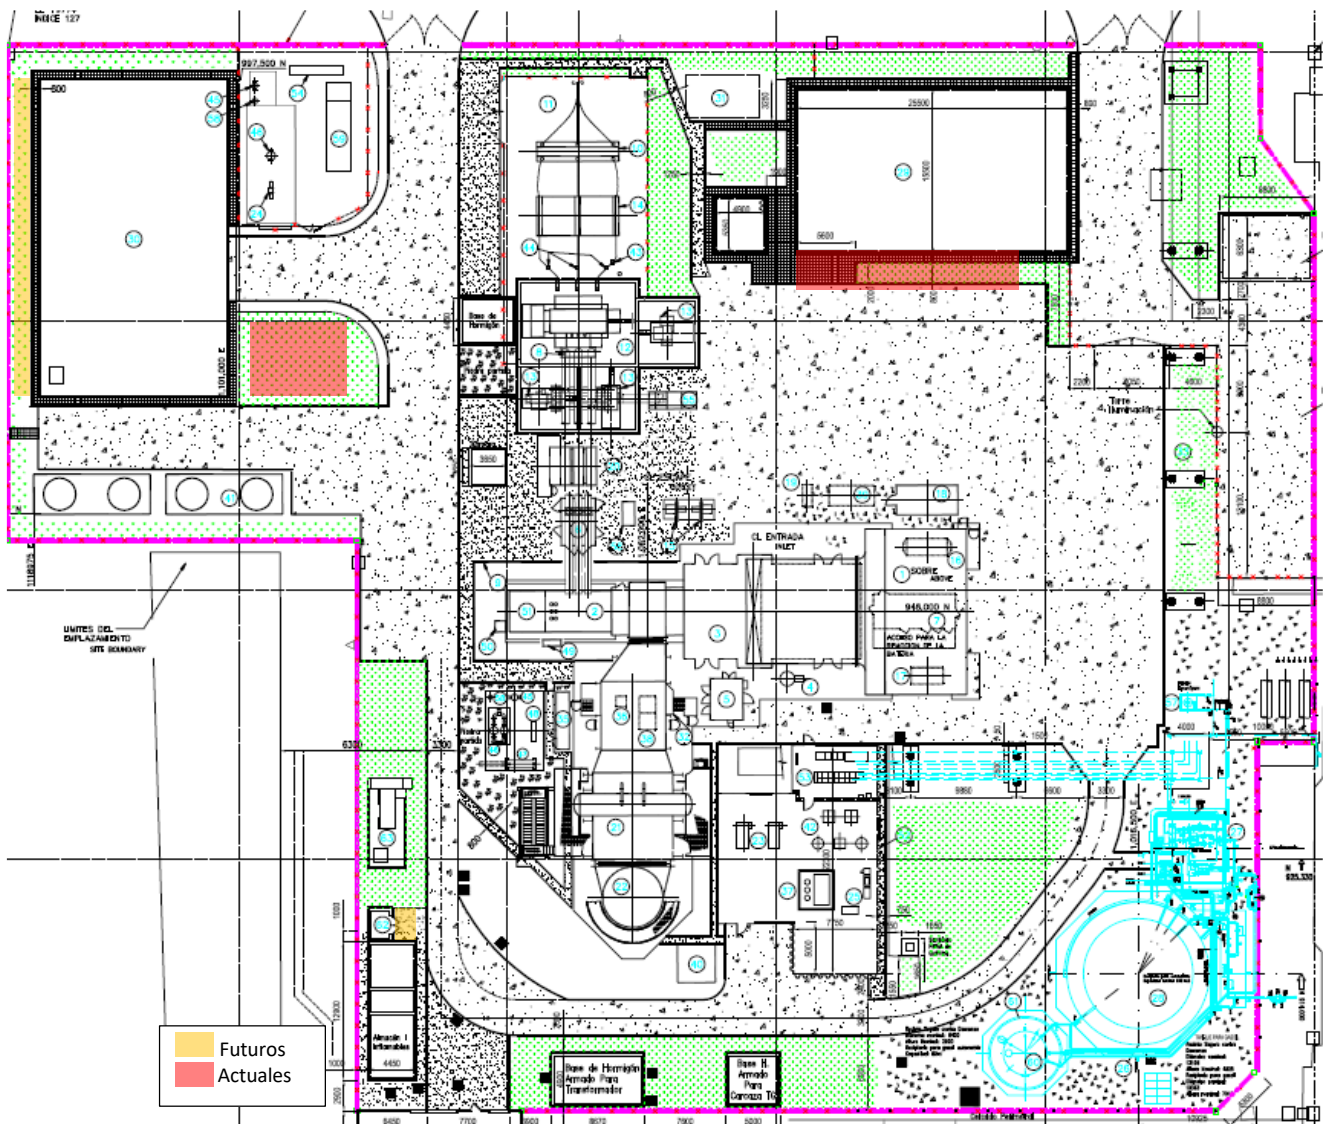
Layout de Planta LPC-1 y Zonas de Ampliaciones Actuales y futuras
